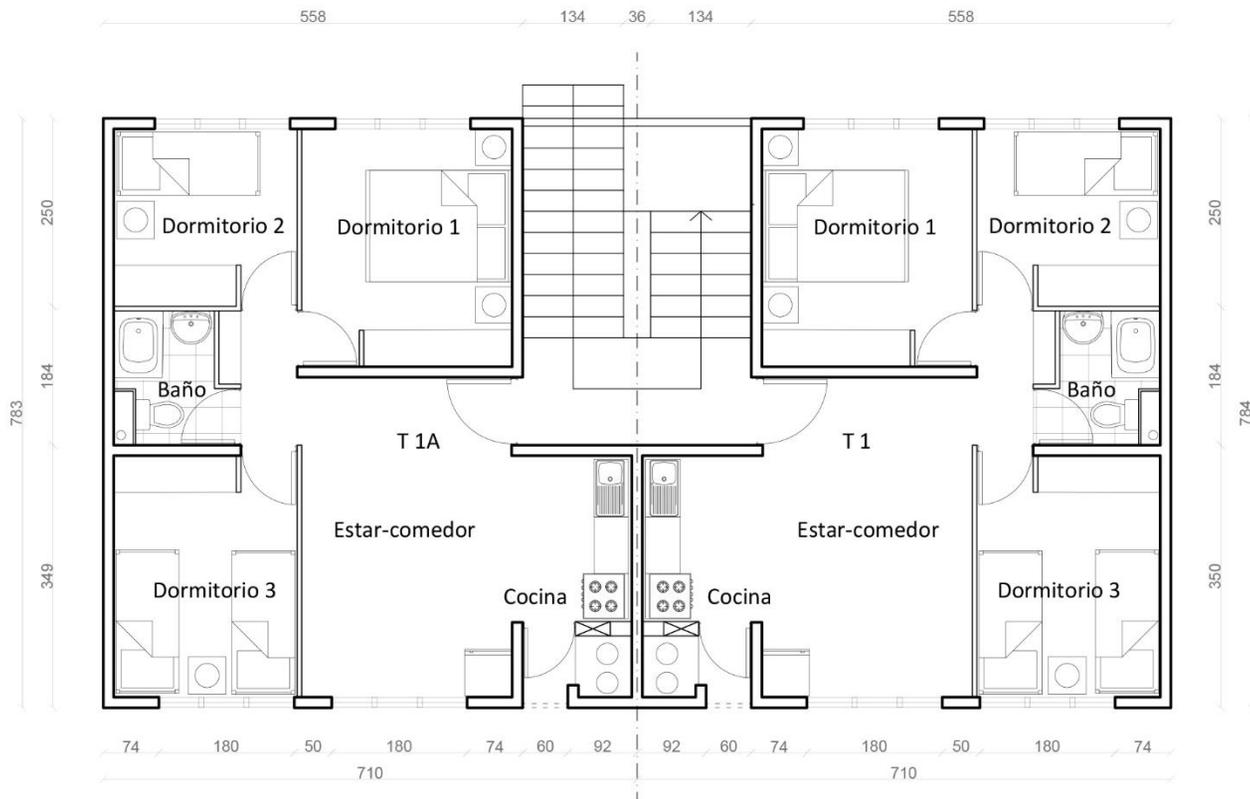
Planta piso tipología 1 y 1A Lo Ermita, esc. 1:100. Fuente: Elaboración propia
